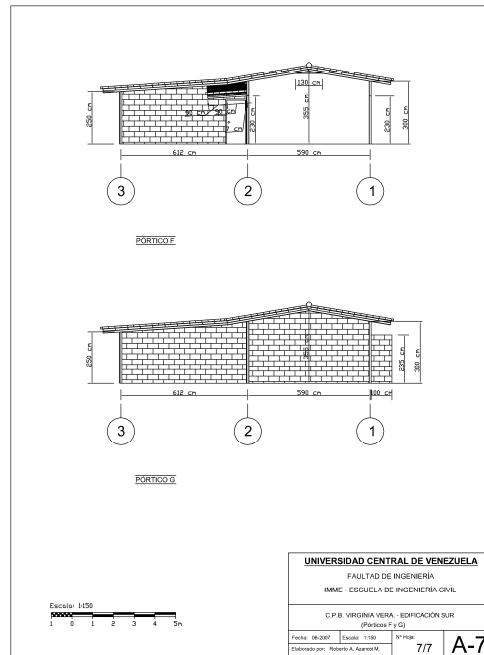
Plano A7: Plano Arquitectónico de los pórticos F y G
